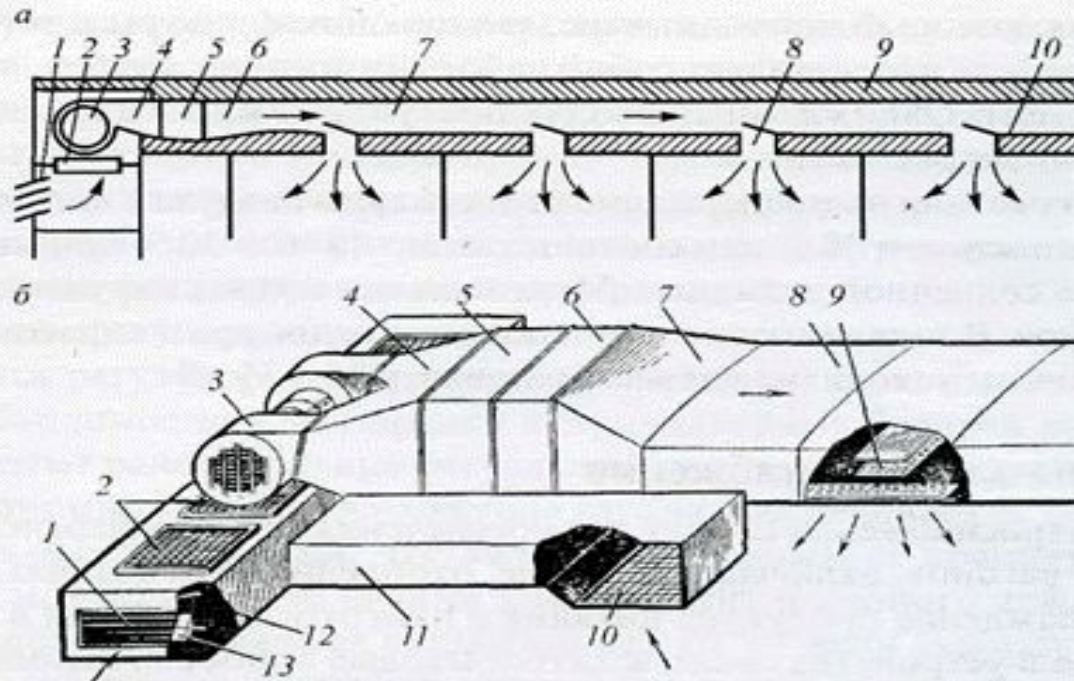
Схема механической приточной вентиляции: *а* — без рециркуляции воздуха: 1 — заборные решетки; 2 — фильтры; 3 — вентиляционный агрегат; 4 — диффузор; 5 — калорифер; 6 — конфузор; 7 — нагнетательный воздуховод; 8 — выпуски; 9 — крыша; 10 — подшивной потолок; *б* — с рециркуляцией воздуха: 1 — решетка забора наружного воздуха; 2 — фильтры; 3 — вентиляционный агрегат; 4 — диффузор; 5 — воздухоохладитель; 6 — калорифер; 7 — конфузор; 8 — нагнетательный воздуховод; 9 — выпуск; 10 — решетка отсоса рециркуляционного воздуха; 11 — возвратный воздуховод; 12 — камера смешения воздуха; 13 — заслонка регулирования подачи наружного воздуха
